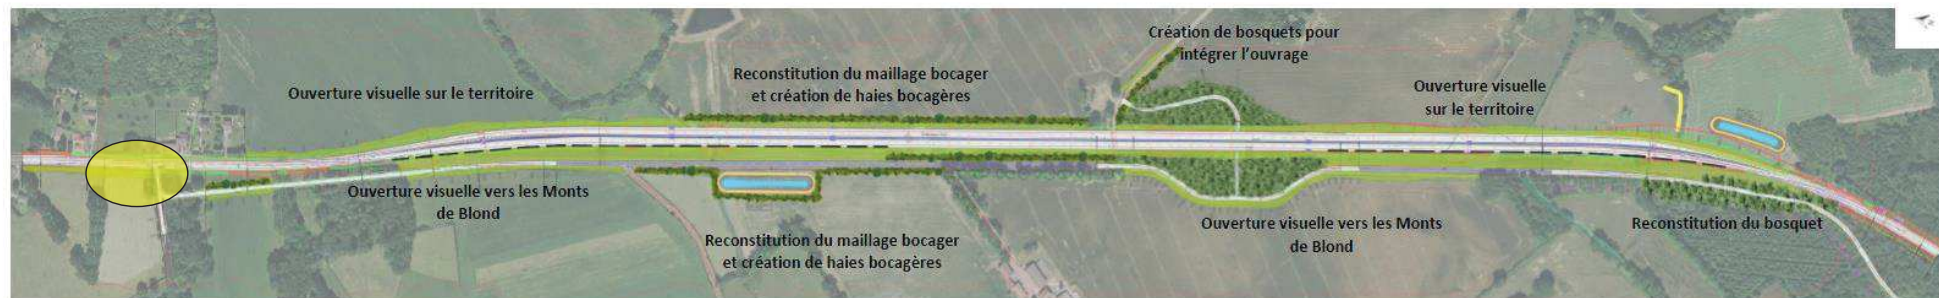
Vue en plan (indicative) des aménagements paysagers sur la section de Chamborêt
